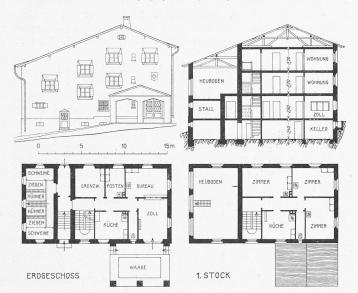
Grundriss, Schnitt und Strassenfront des Zollhauses Splügen. — 1:400.
